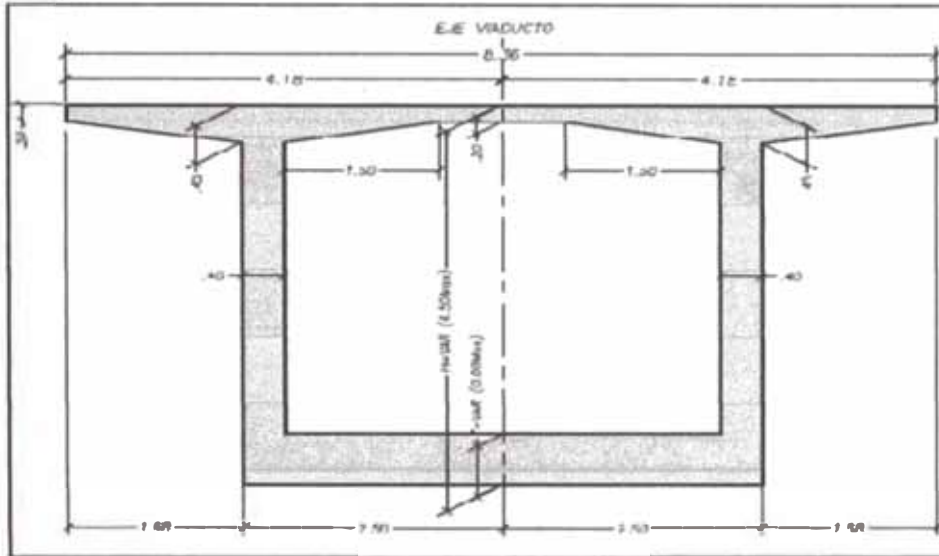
Sección transversal del Tablero sobre Pilares S50 y S51
